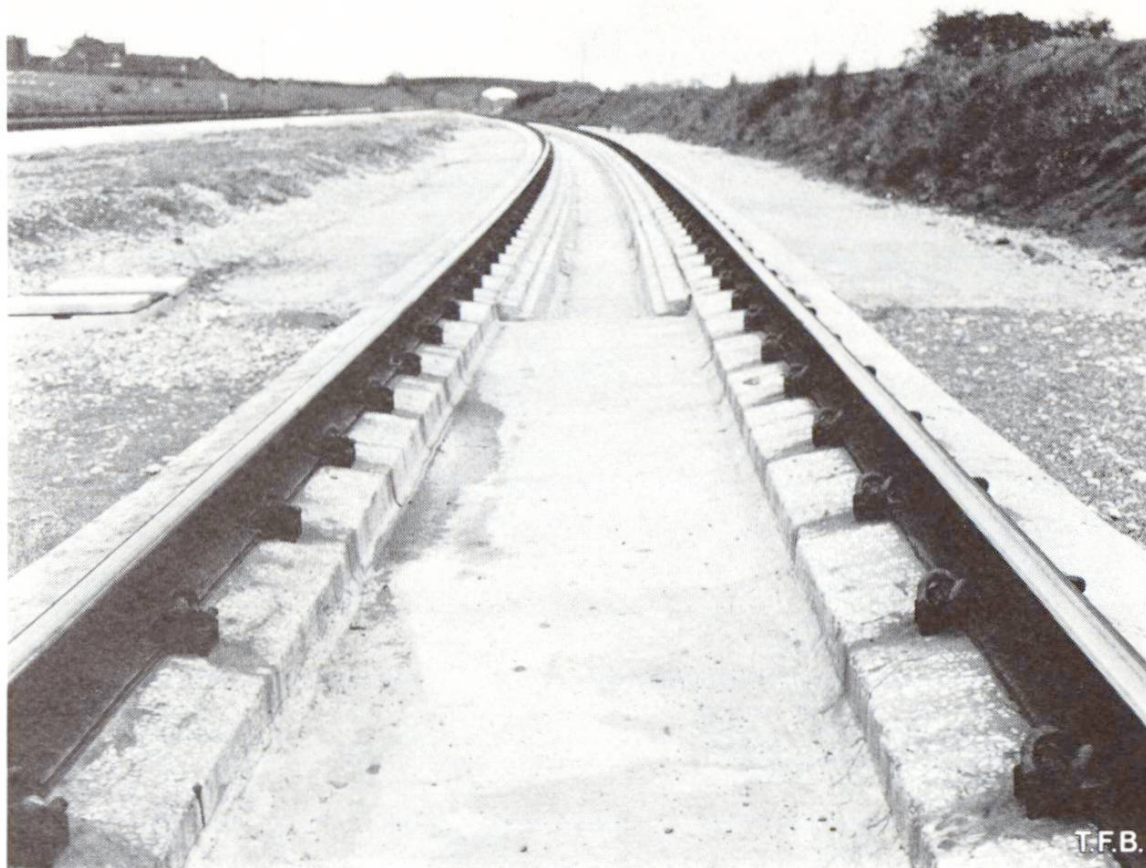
Versuchsstrecke für den Geleisebau in einem zukünftigen Tunnel unter dem Aermelkanal.
